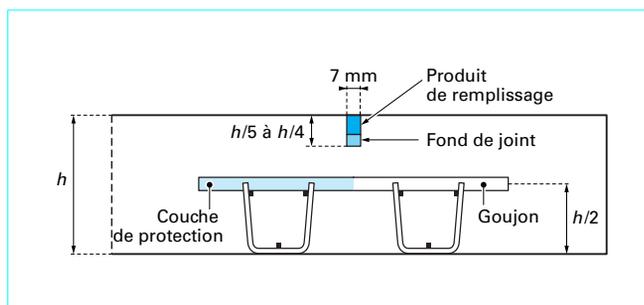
Joint transversal goujonné de dalles en béton goujonnées (BC_g)
